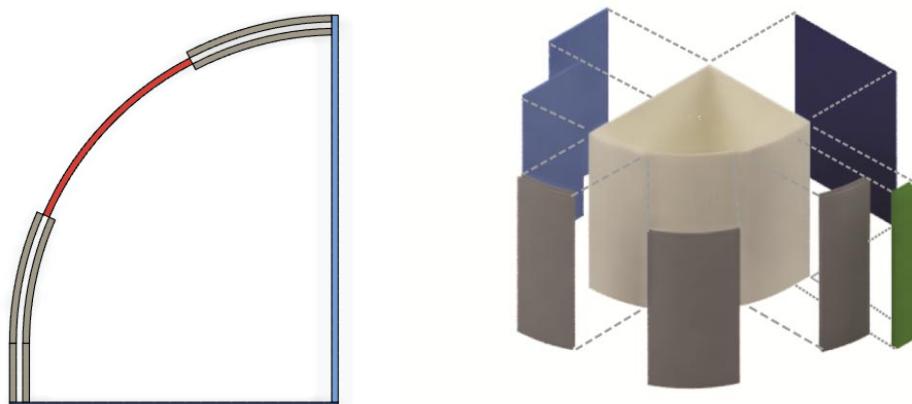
Alternatif 1 Konfigurasi Panel *Universal Lavatory Module
